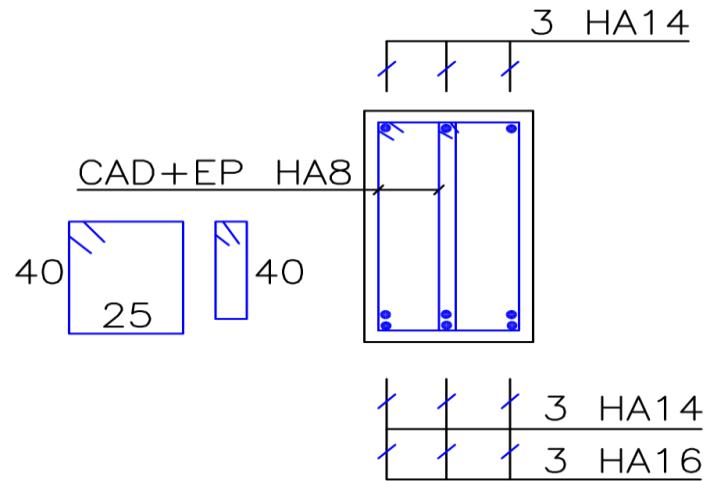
Ferrailage des poutres principales au niveaux 7^{ème} étage et 8^{ème} étage
